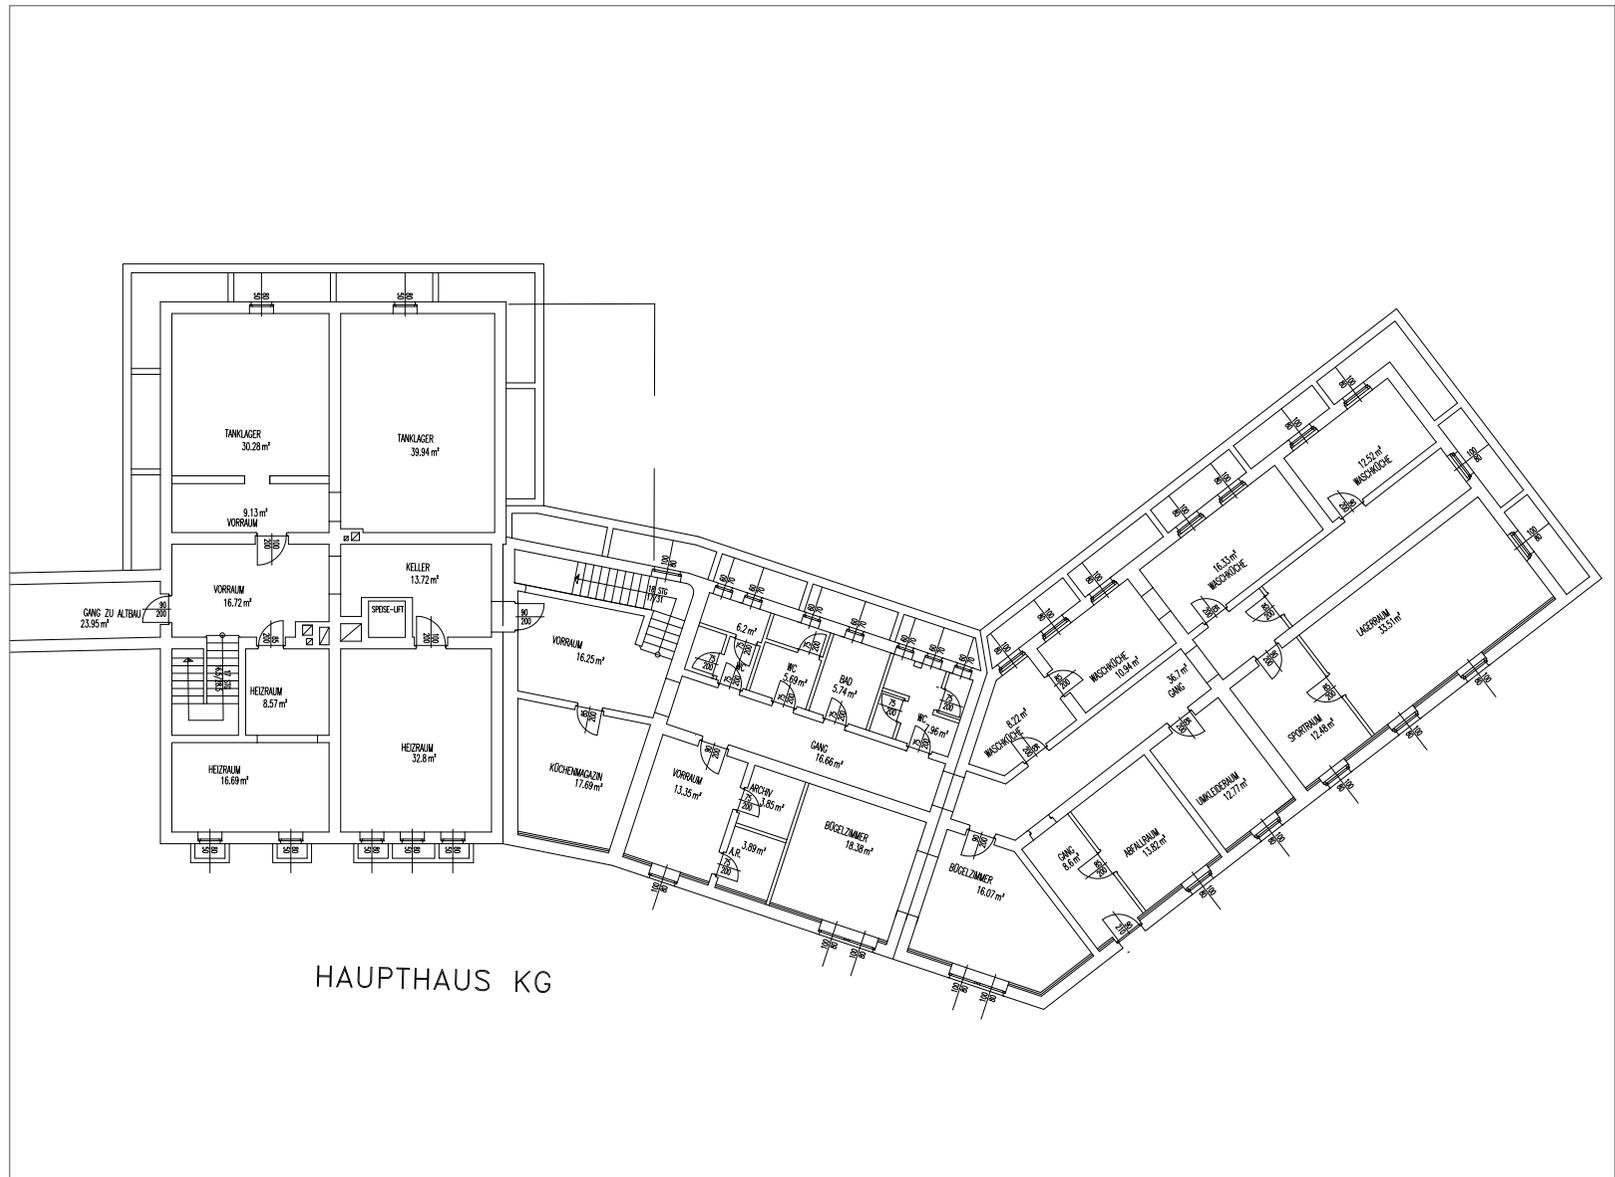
Grundriss des Haupthauskellers, ehemaliges LJH Rosenhof (Hartsleben 1999)
